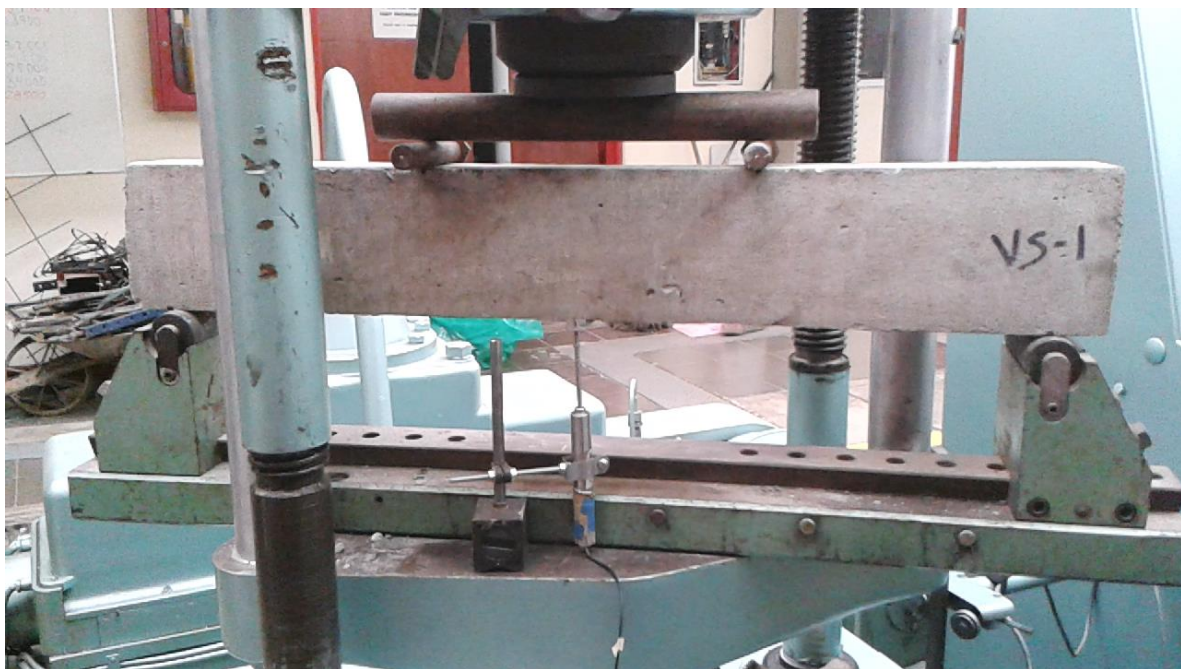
Viga VS-1 al inicio de la prueba
